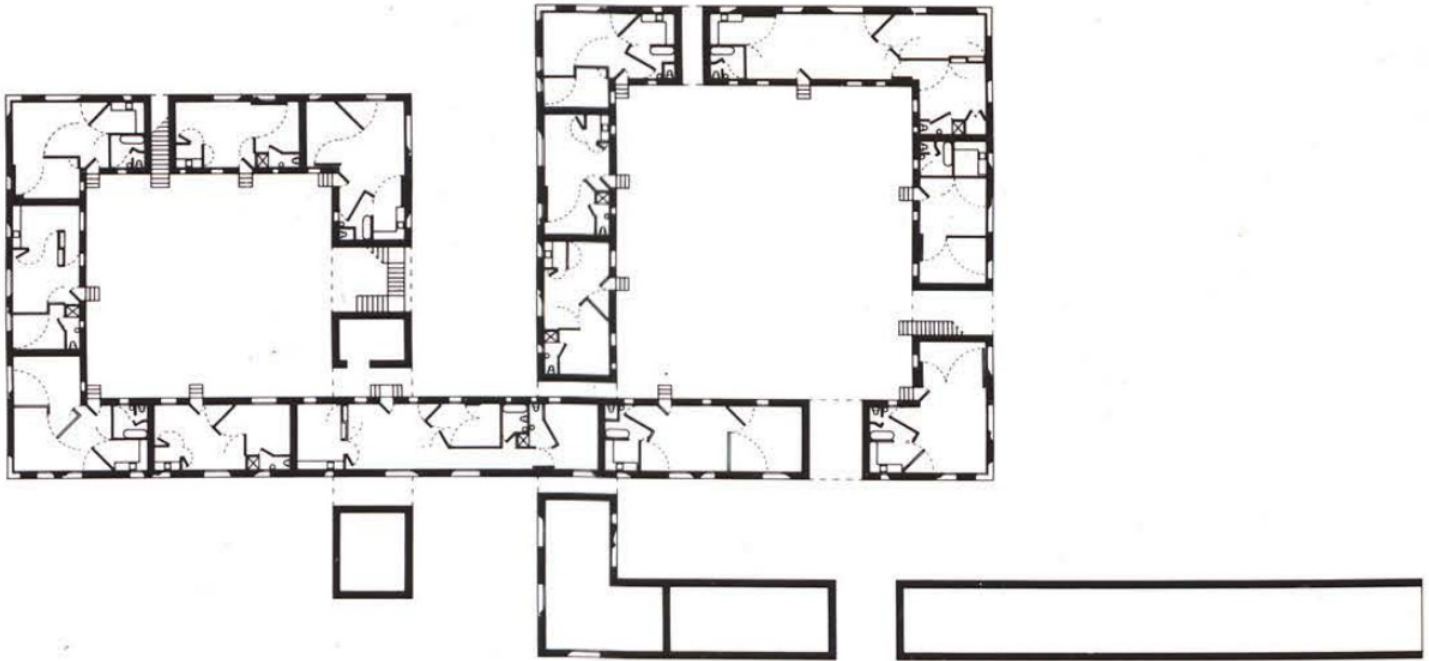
Pianta delle *Spatial retaining bars*, Phoenix, Steven Holl
